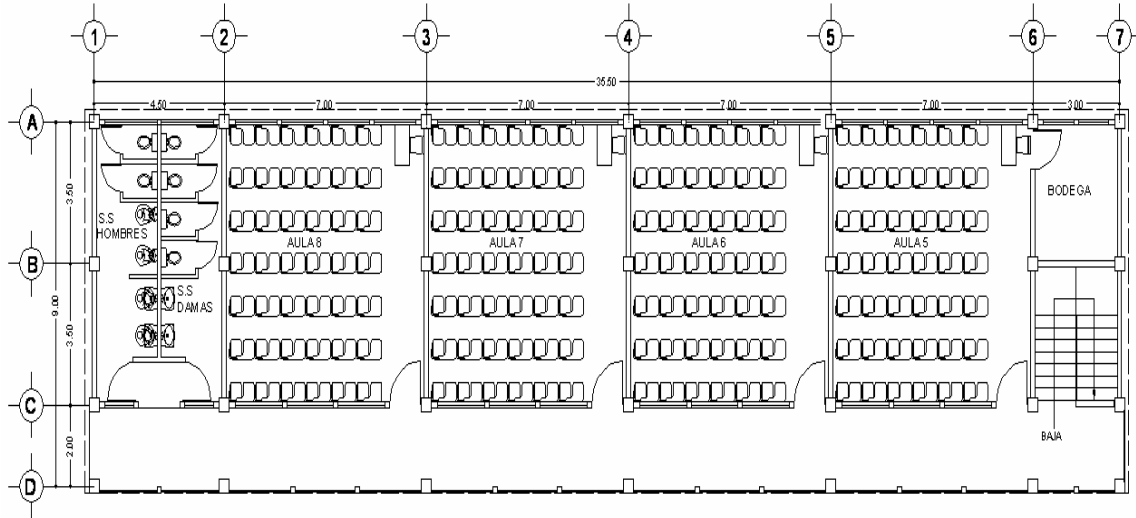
Planta amueblada segundo nivel, módulo de aulas
